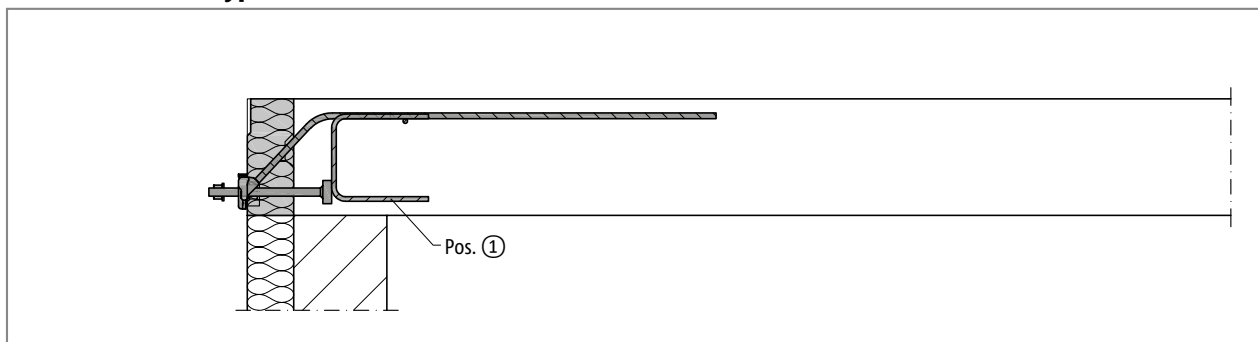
Schöck Isokorf® T type SQ: in het werk aangebrachte brandwerende bekleding T type SQ, staalconstructie met brandwerende coating; doorsnede
